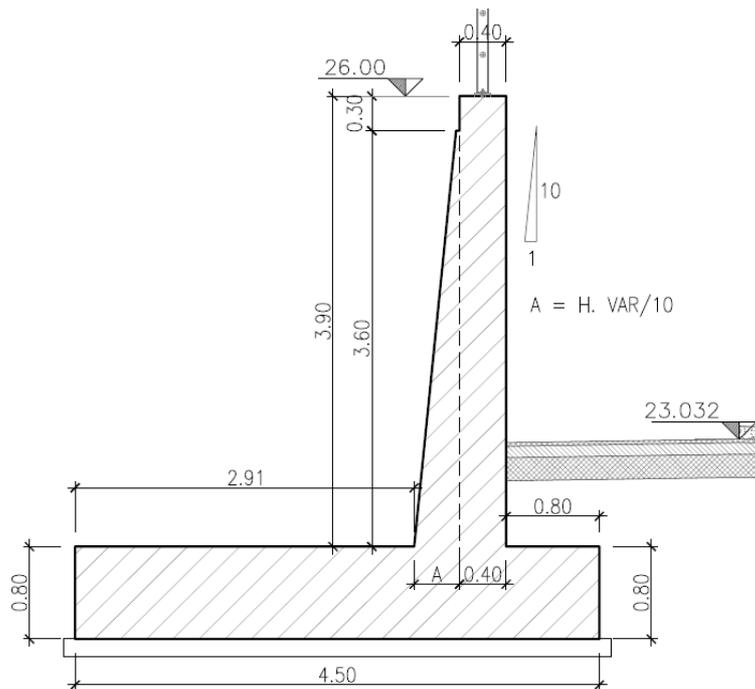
Muri di sbocco/imbocco a mensola - Sezione trasversale
